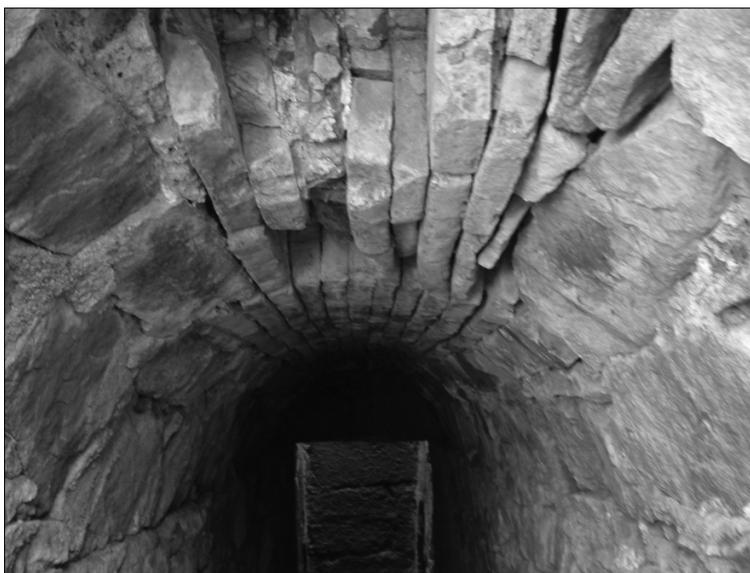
Detalle de la cubierta en el tramo de conducción en el área de Las Tomas; acueducto de San Lázaro.
